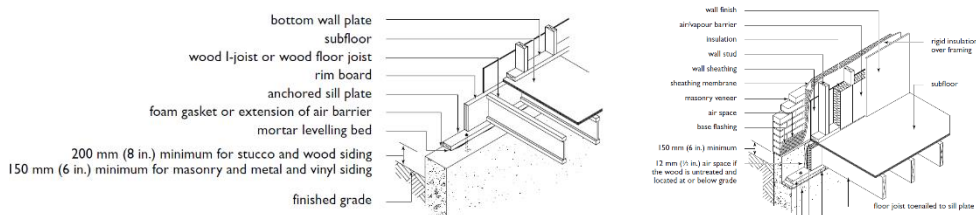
Ligações da estrutura de pavimento às fundações: método mais comum ("da travessa de soleira") e método alternativo ("vigota de pavimento embebida") com ressalto para cotas de pavimento mais baixas (CMHC, 2013a).
